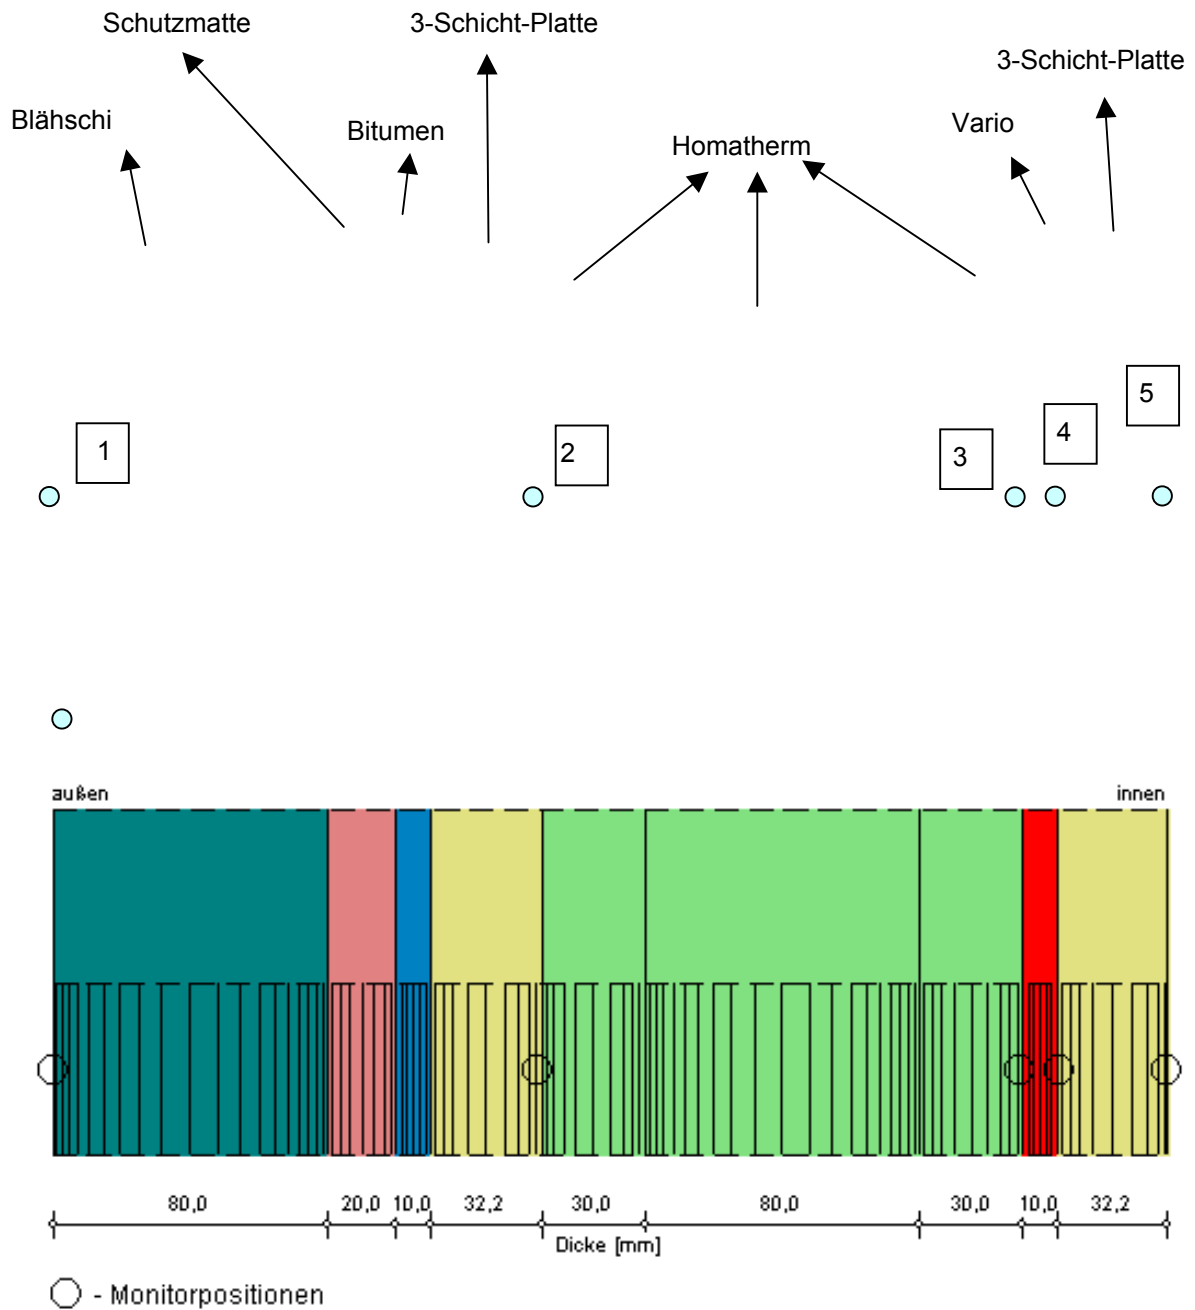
Modell des Dachaufbaus für die Sporthalle Riedmatt (mit Dampfbremse warmseitig).
